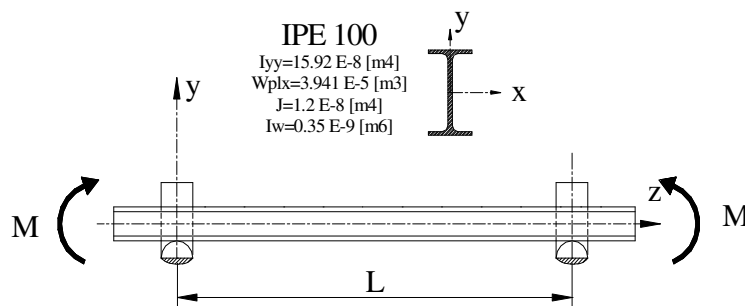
Viga duplamente simétrica, em estado de flexão pura, com dois apoios de forquilha.
